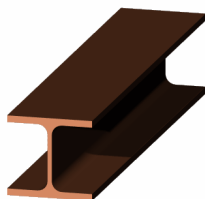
Poutre en acier IPE Figure 158. Poutre alvéolaire
